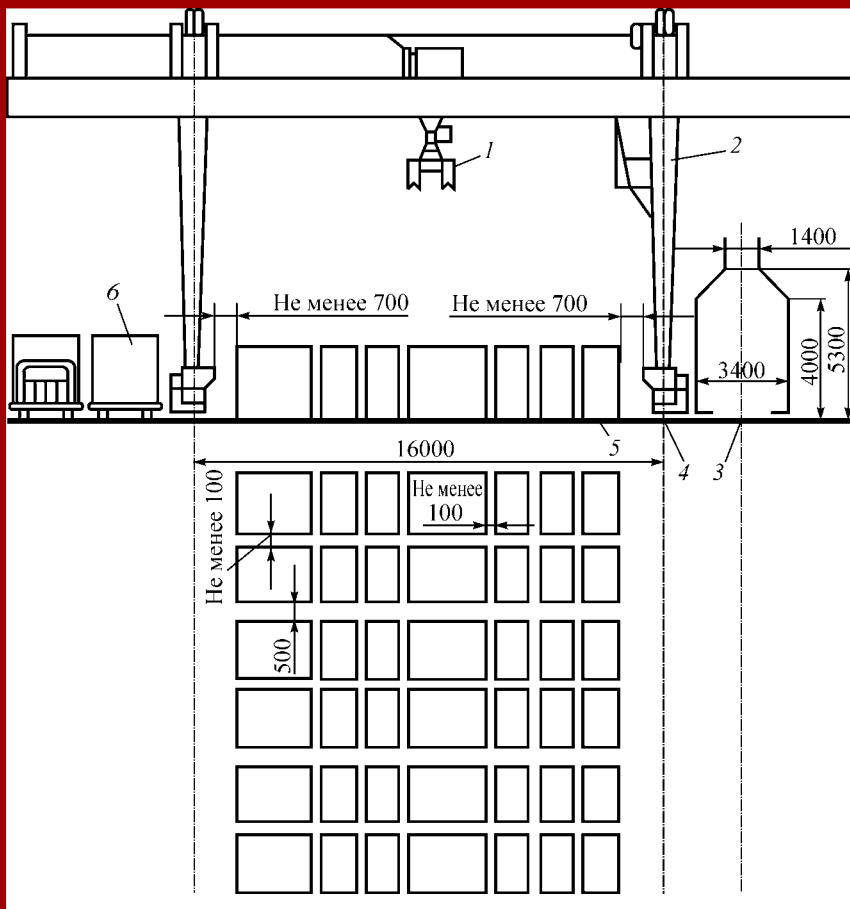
Схема комплексной механизации и размещения среднетоннажных контейнеров на площадке с одним погрузочно-выгрузочным путем, обслуживаемой козловым краном пролетом 16 м: 1 — автостроп, 2 — козловой кран грузоподъемностью 6 т; 3 — железнодорожный путь, 4 — подкрановый путь; 5 — контейнеры; 6 — автомобиль
